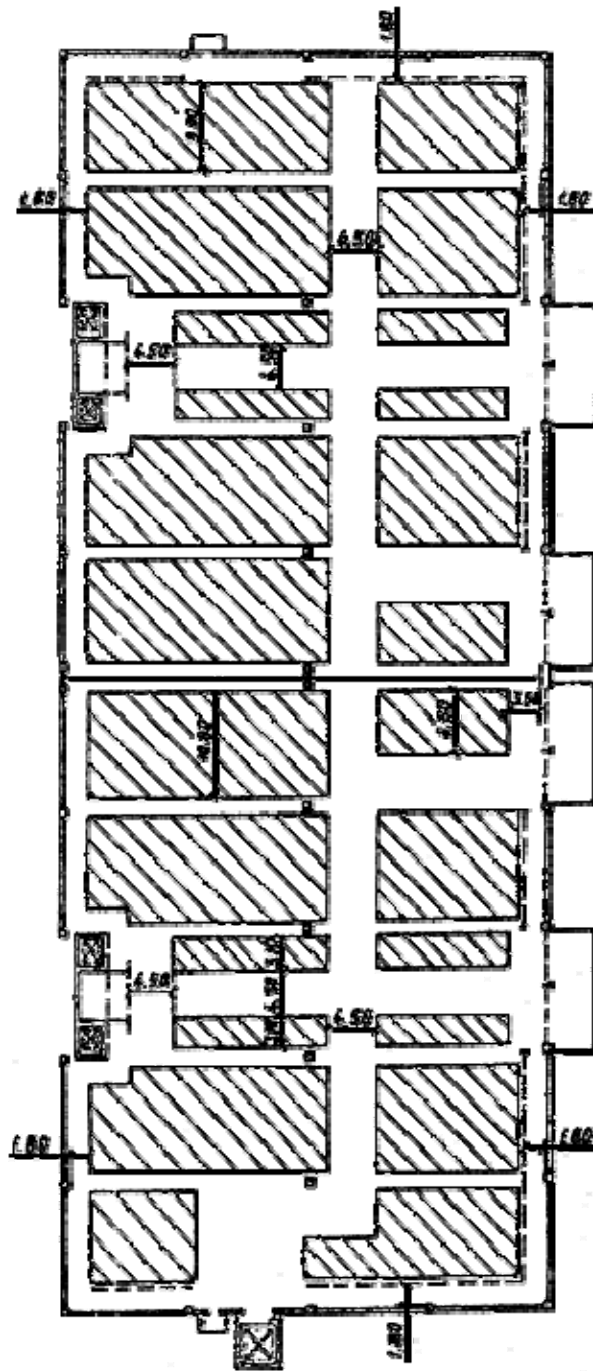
Пример схемы допускаемых нагрузок для крытого грузового склада.
